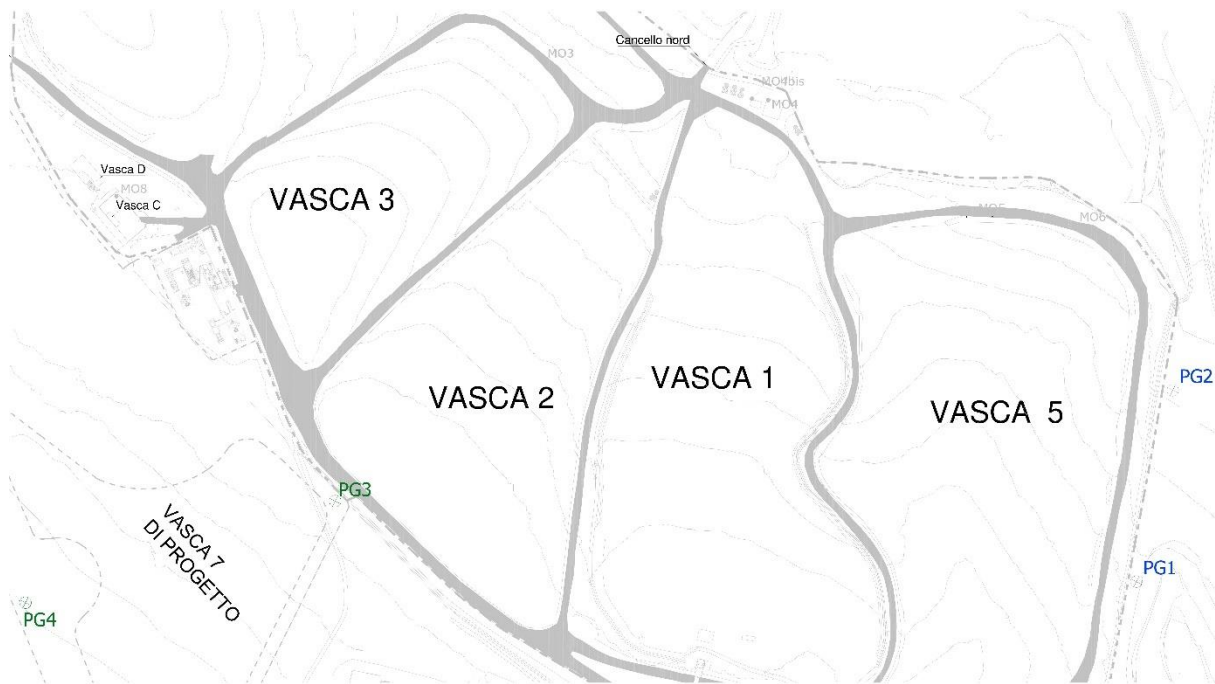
Stralcio planimetrico dei punti di monitoraggio fughe di gas dal suolo
